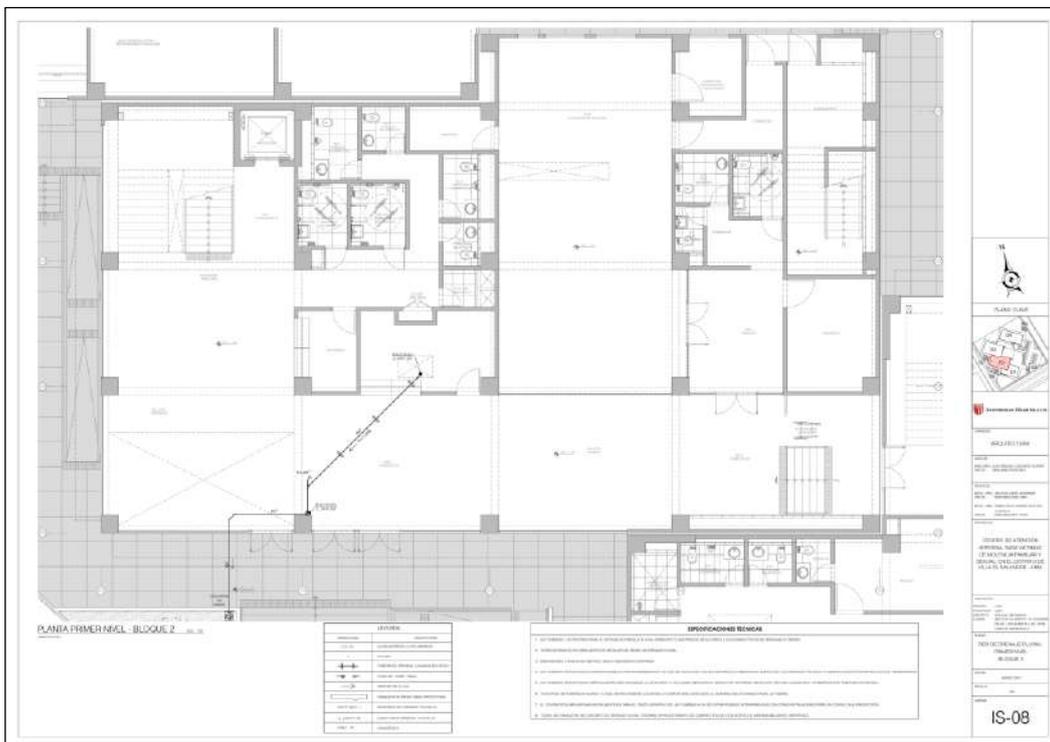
Planta primer nivel red de drenaje pluvial – bloque 2.
